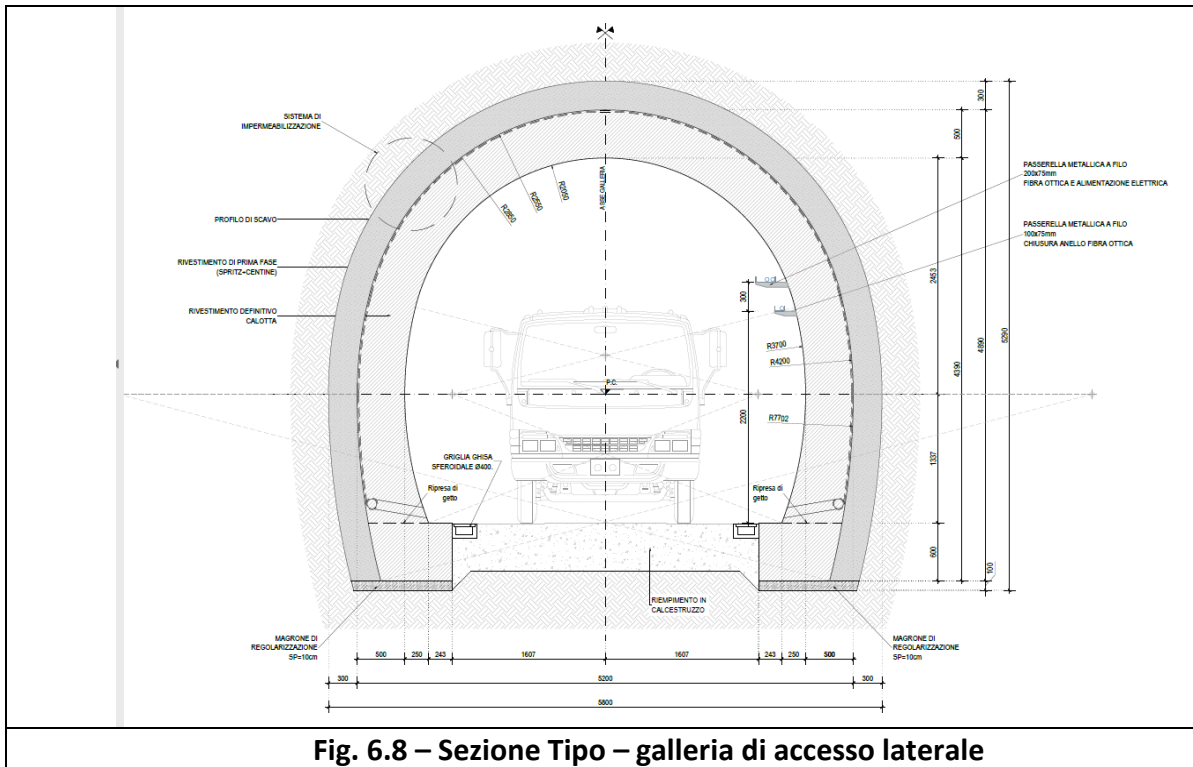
Sezione Tipo – galleria di accesso laterale
